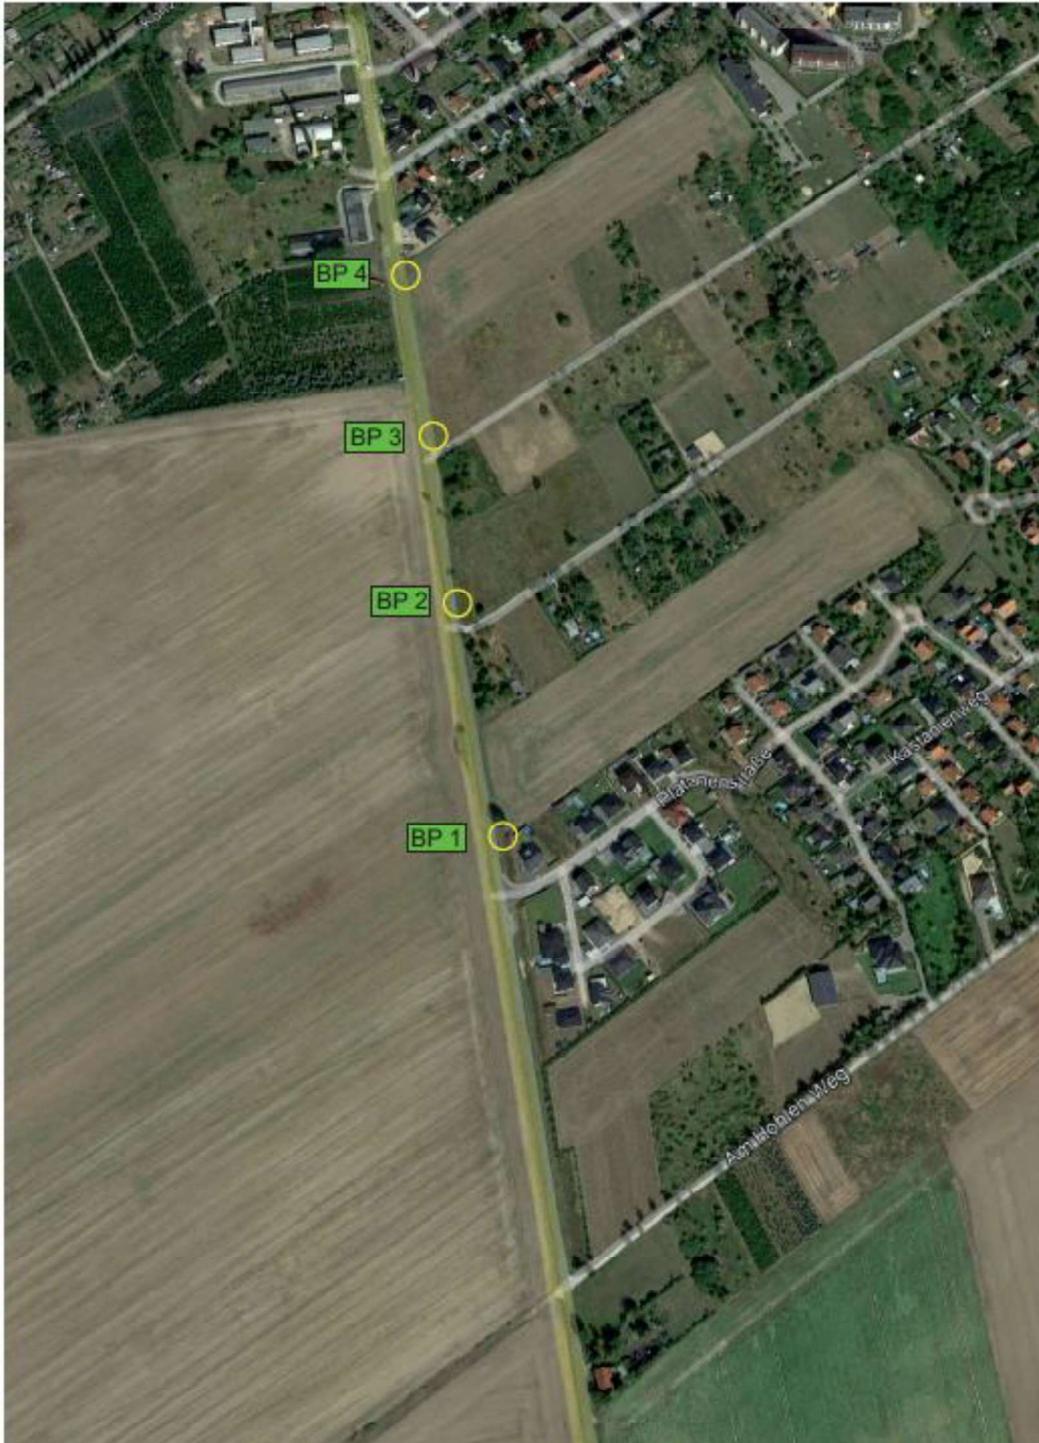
Baugrunduntersuchung Ingenieurbüro Lehmann Stendal OT Uenglingen, Neubau Radweg K 1037, Anlage 2 Übersichtslageplan
